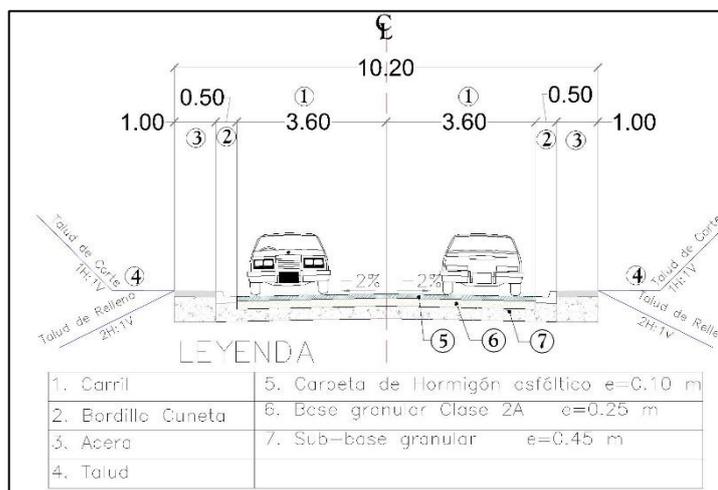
Sección Transversal Tipo 5, Alternativa 3.
